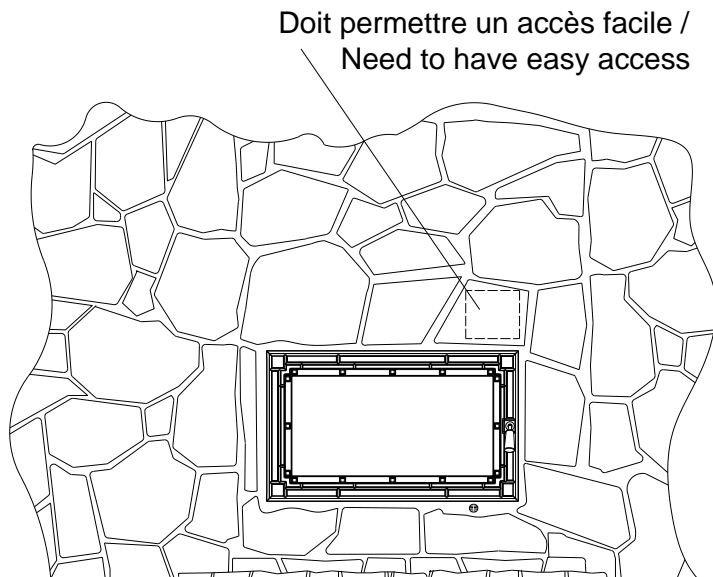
Exemple de devanture avec la maçonnerie / Example of facing with masonry
